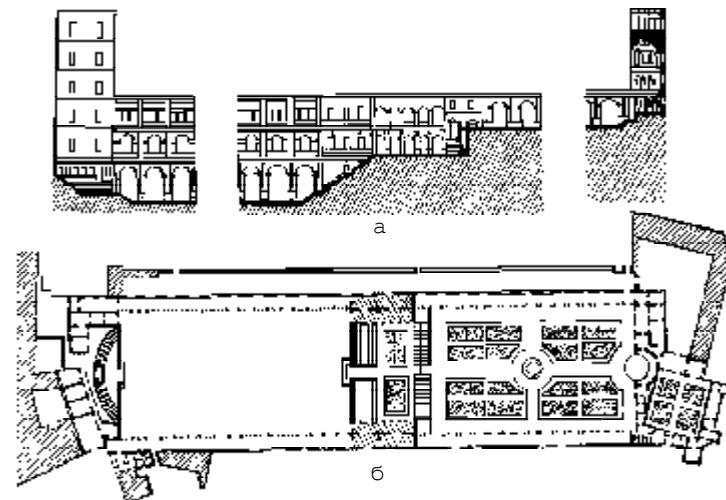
Двор Бельведера в Риме: а — продольный разрез; б — план
